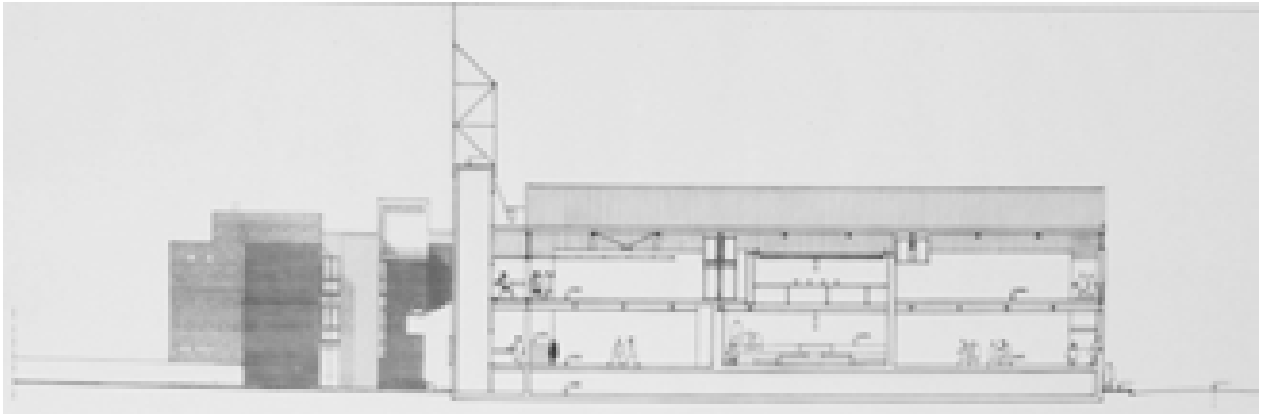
Sezione DD, stato finale –29/01/2002 (AABS-1996.8)
